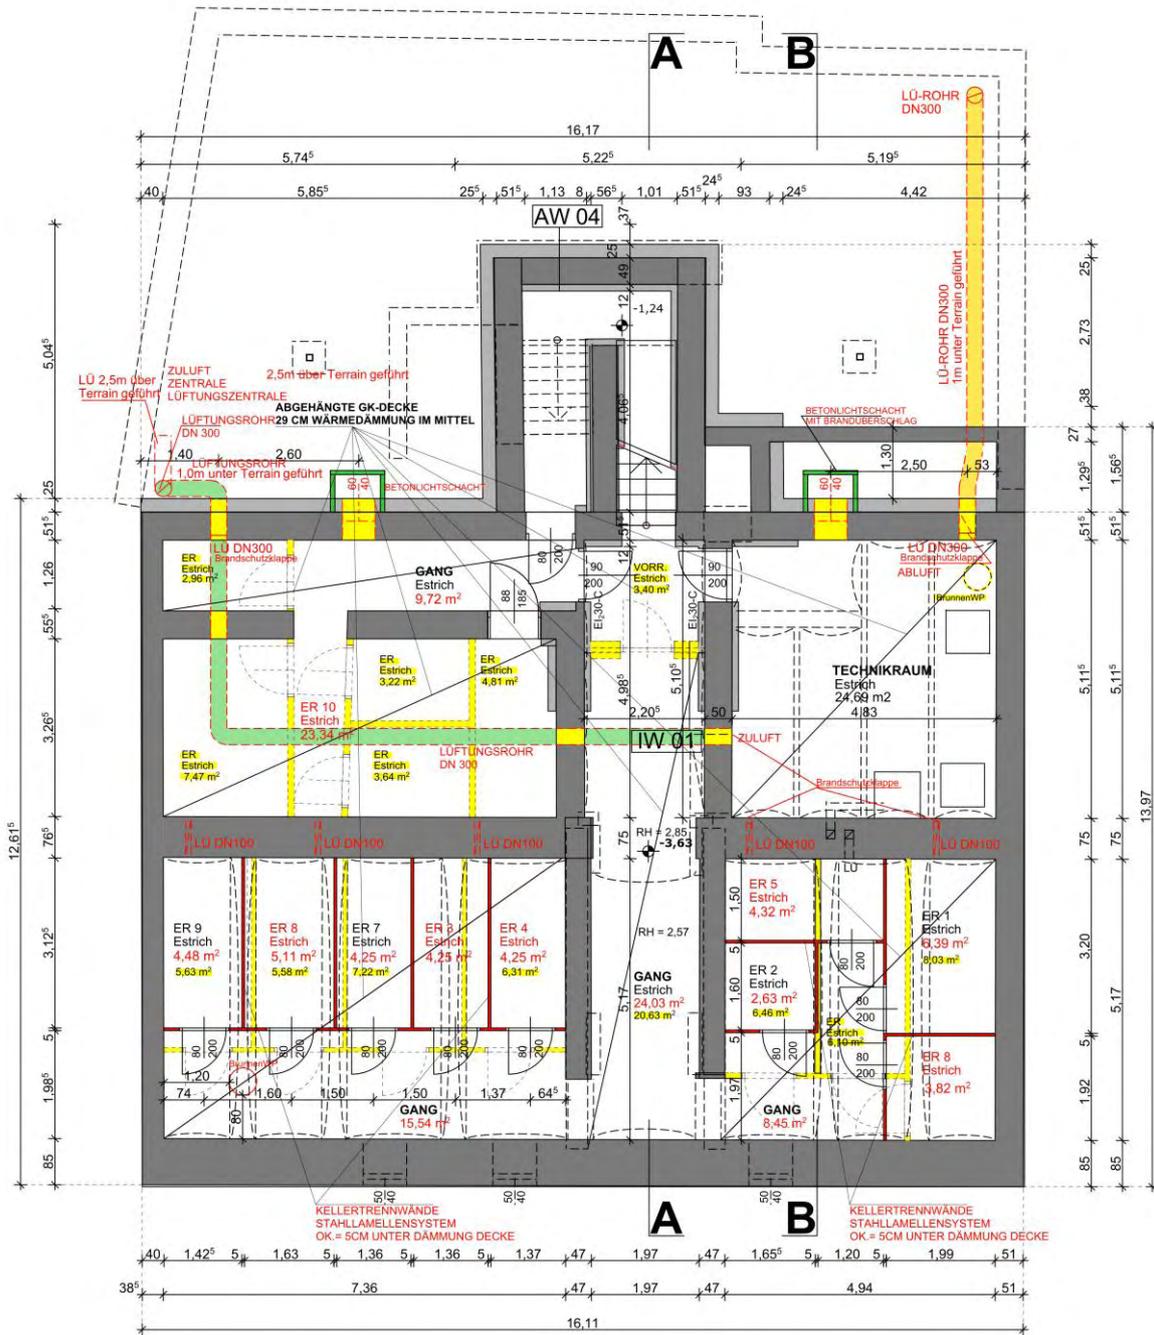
Grundriss Kellergeschoß mit Lage der haustechnischen Komponenten [Quelle: Ageres Baumanagement]
